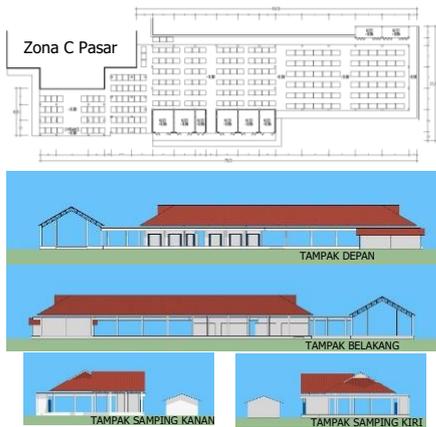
Denah dan tampak zona C pasar Tradisional Towo'e
